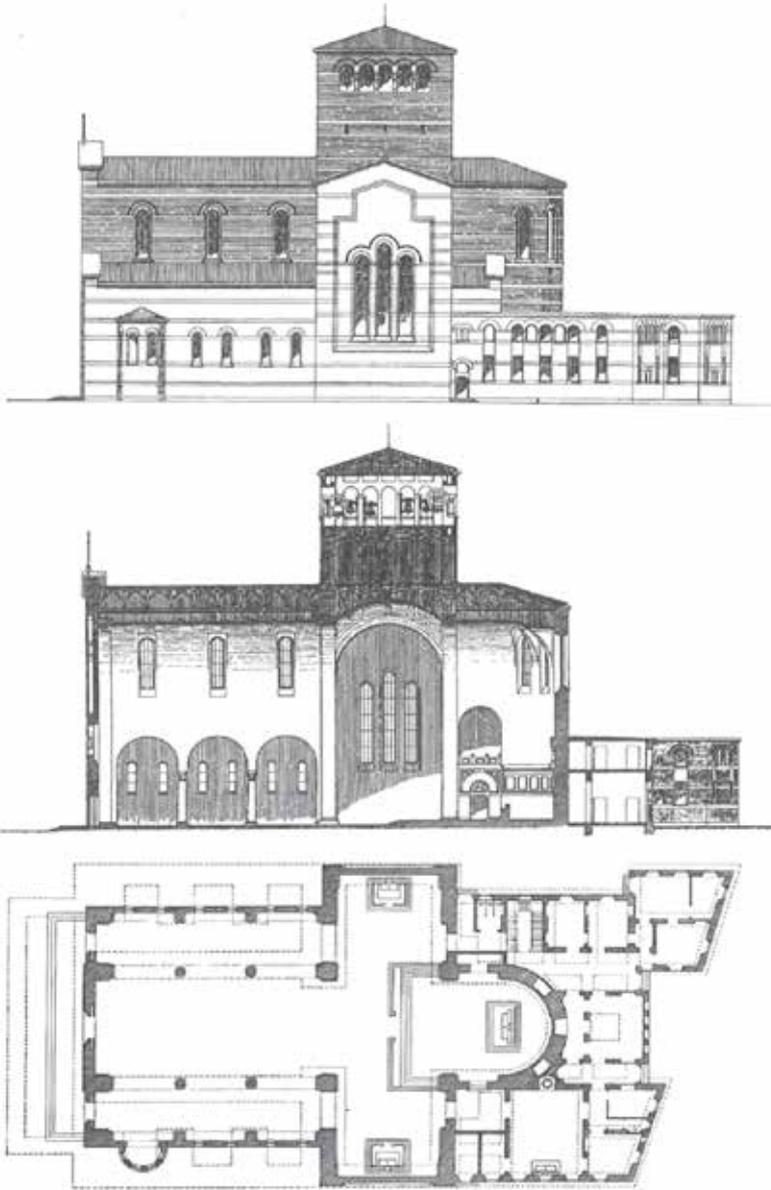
Mario Ceradini, terza versione del progetto della chiesa: prospetto laterale, sezione e pianta.
